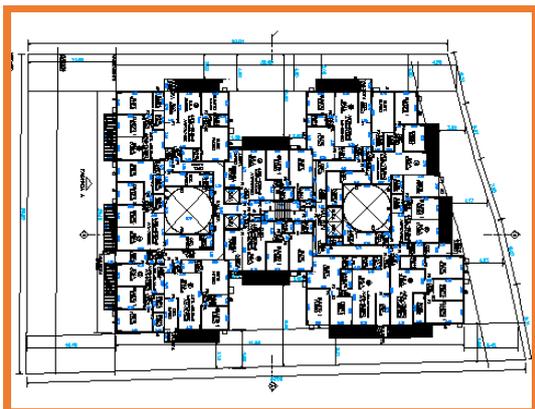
Pavimento Tipo e Último tipo – Fonte: Projeto Legal
